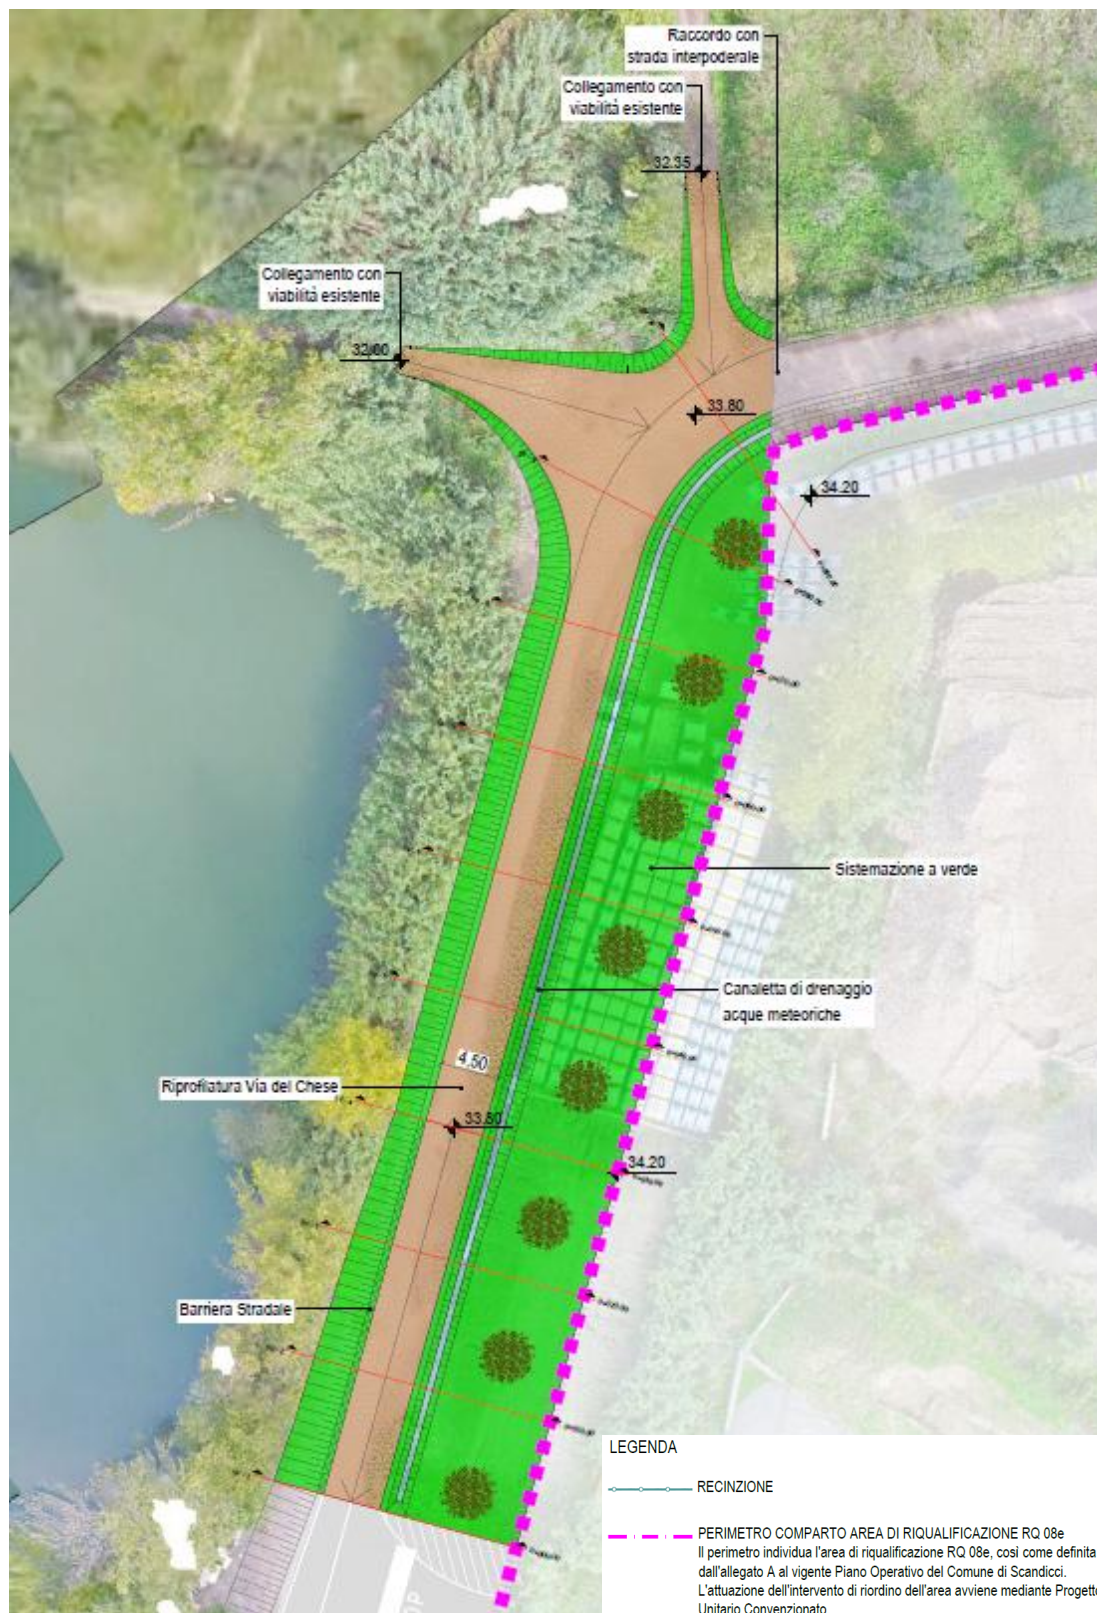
Viabilità vicinale, planimetria di dettaglio
